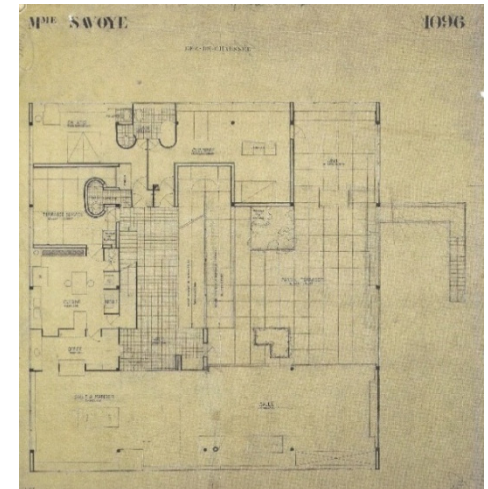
Vila Savoye, primeira proposta. Planta do primeiro pavimento. Fonte: Fundação Le Corbusier.
